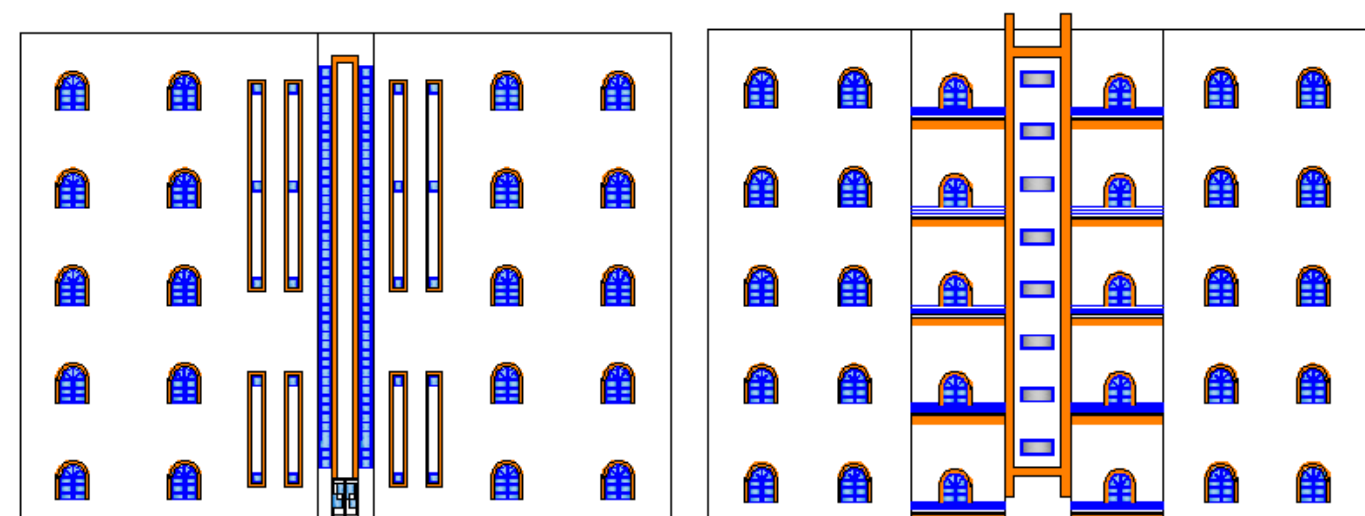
Vue façade du bâtiment (principale et postérieure).
